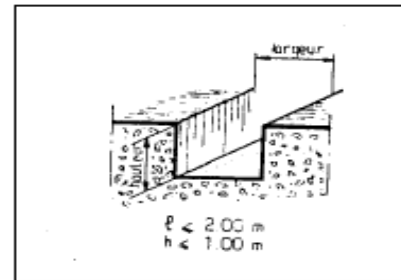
Fouilles en trous pour fondations : Elles correspondent aux semelles isolées (ex: fondations sous les poteaux, sous les murs isolés de petites dimensions).
